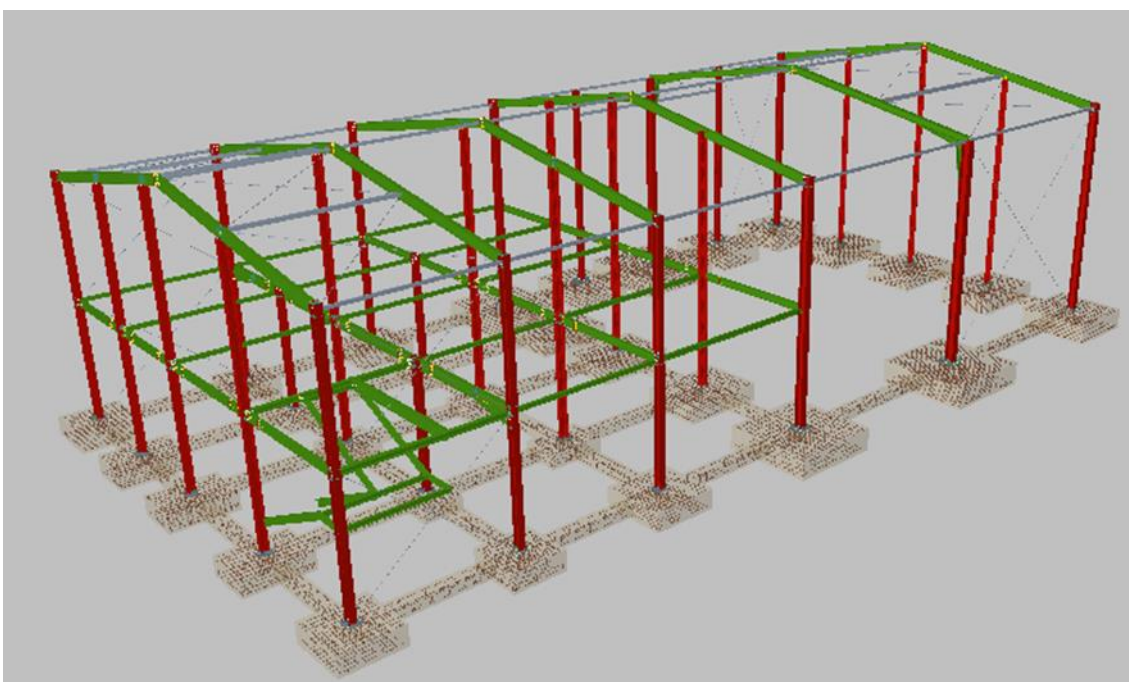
Estructura de la nave y cimentación en 3D (vista derecha)
